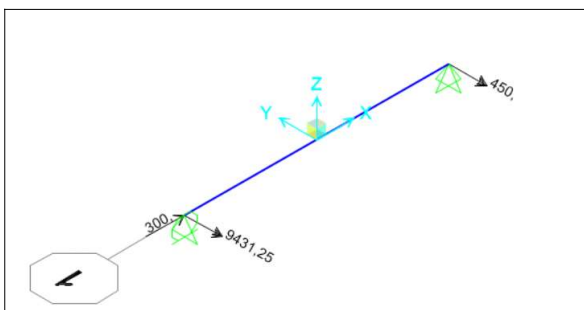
SAP2000: Cargas aplicadas modelo elemento viga-columna, $P=300$ [tonf]
